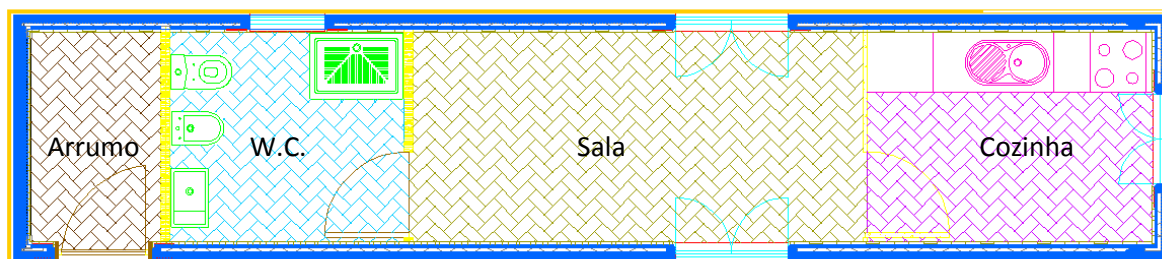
Planta da unidade modular T0 (*cad*)
